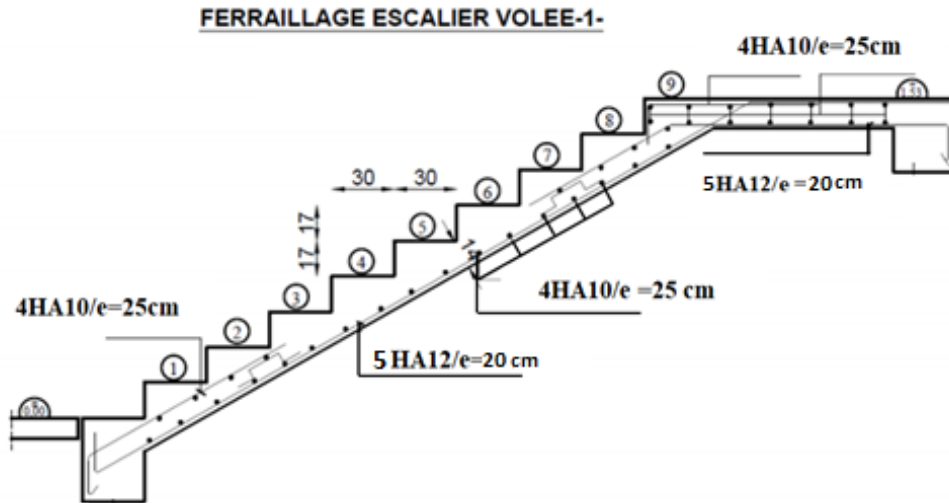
Schéma du ferraillage des escaliers.
